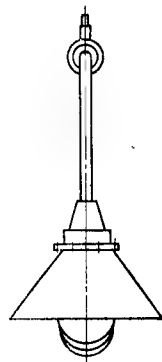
Разделительное уплотнение с помощью фитинга ФПЗ на вводе в светильник.
